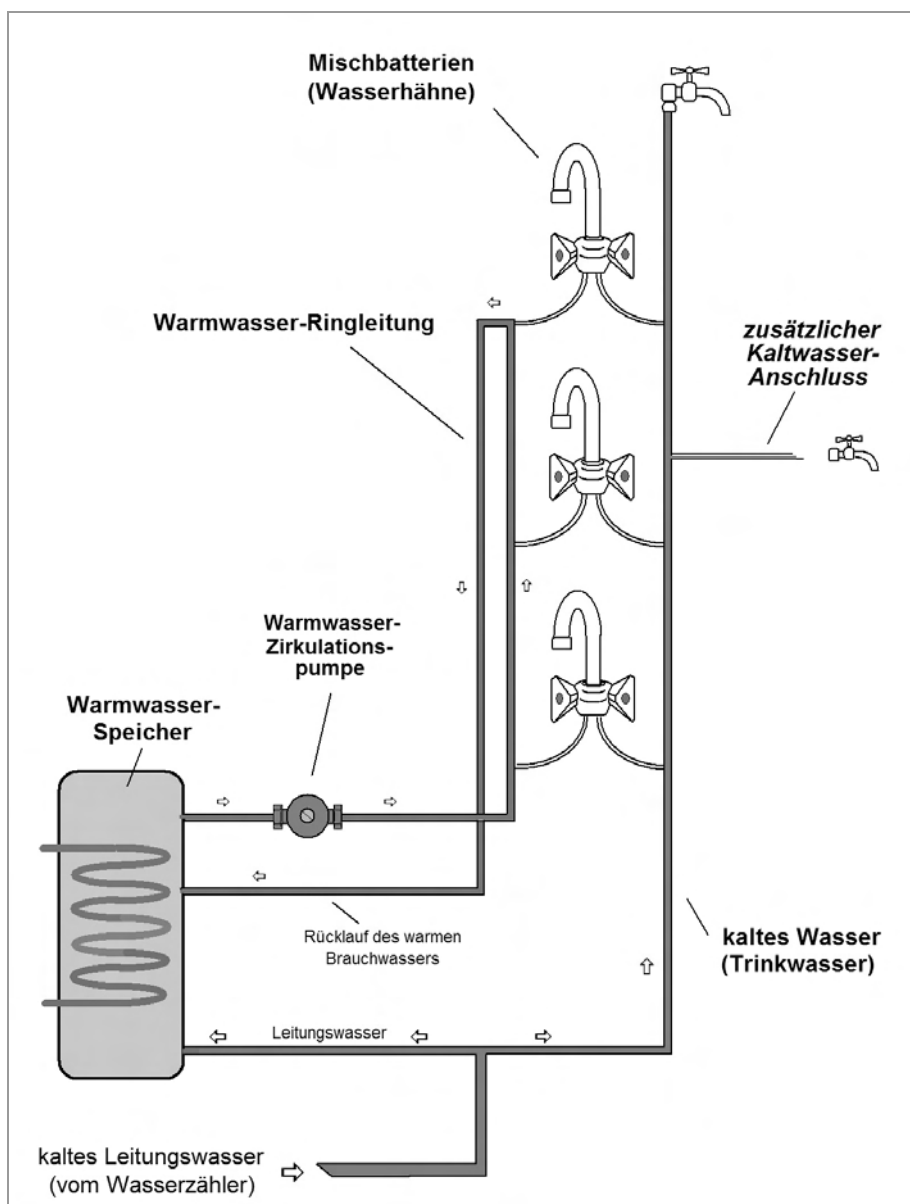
Der Anschluss einer zusätzlichen Kaltwasser-Leitung ist einfach, da er an beliebiger Stelle der bestehenden Leitung angezapft werden kann.
